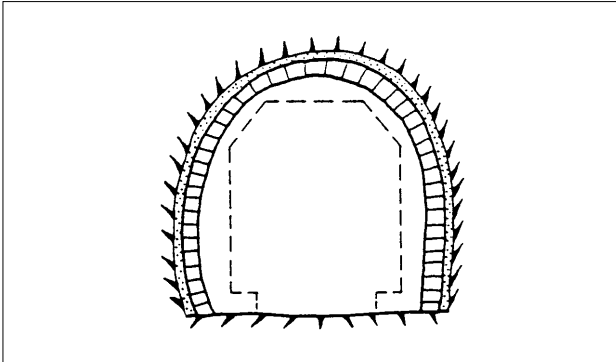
Tunnel ferroviaire avec habillage en pierre naturelle:
